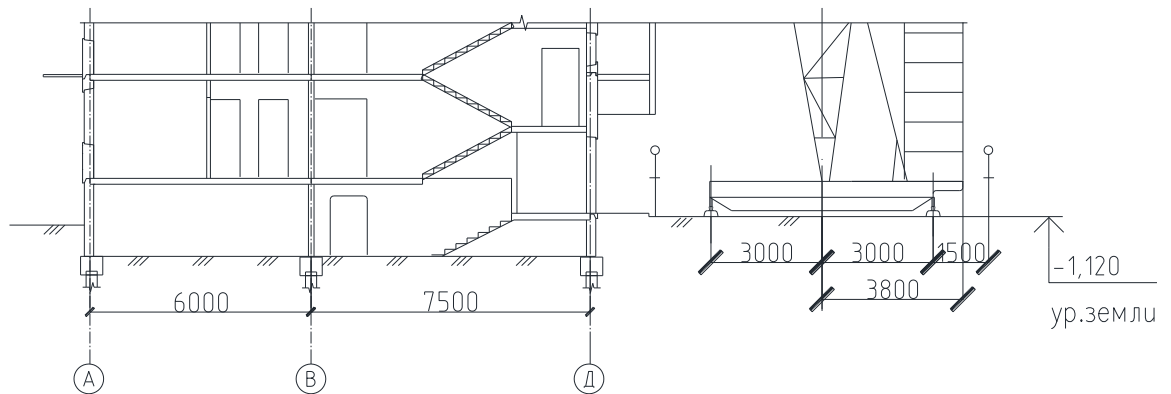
Поперечная привязка башенного крана КБ-405-1А
